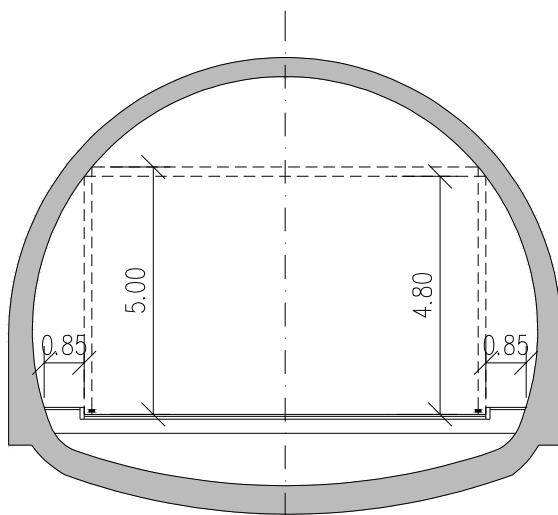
Tunnelquerschnitt		Fig. VII-01 Sezione in galleria
